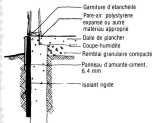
ISOLATION DES DALLES SUR LE SOL
